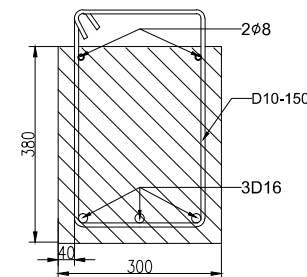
DETAIL PENGANGKATAN BALOK ANAK BENTANG 4.5m
